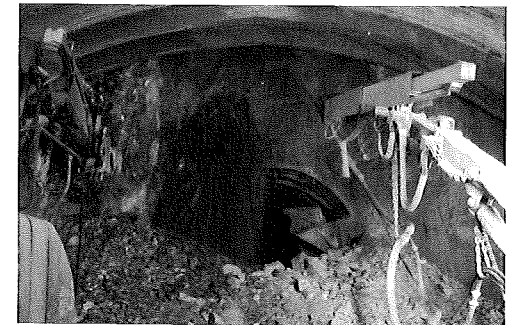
地質不良部切羽状況 (DII-B-P, 砂質)
